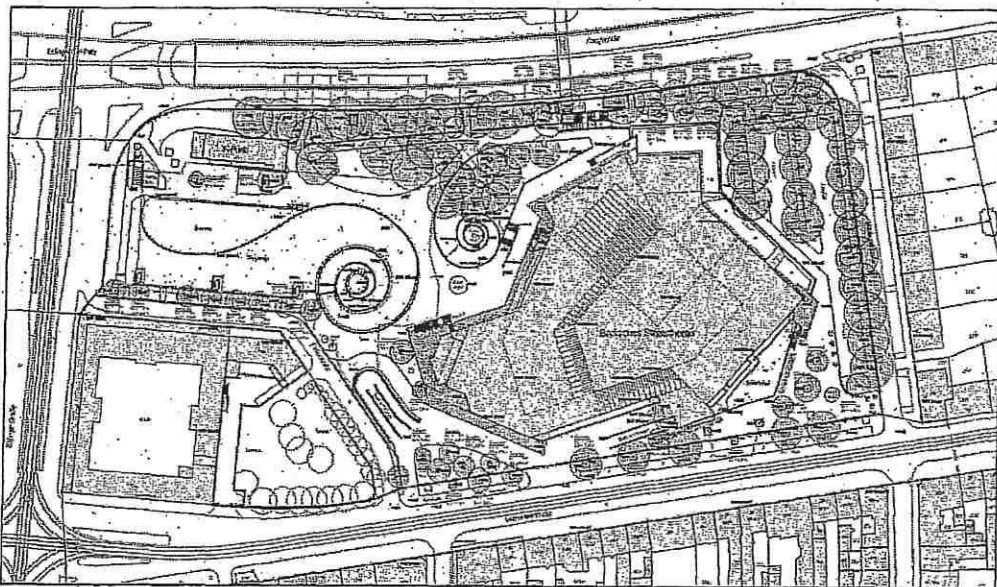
Lageplan Badisches Staatstheater vor der Modernisierung
